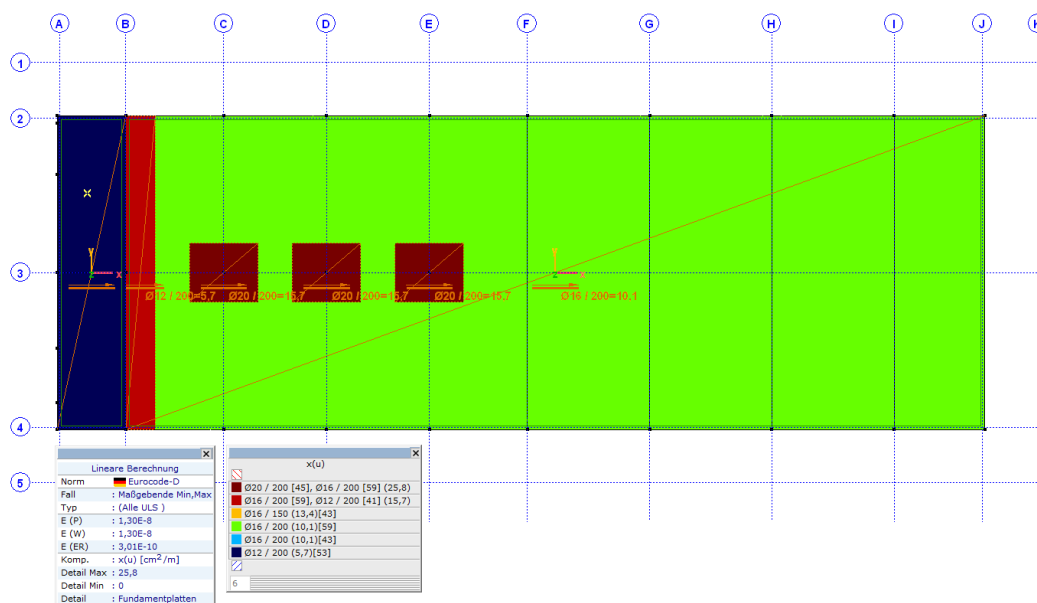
Entwerfene untere Bewehrung in lokaler x-Richtung
